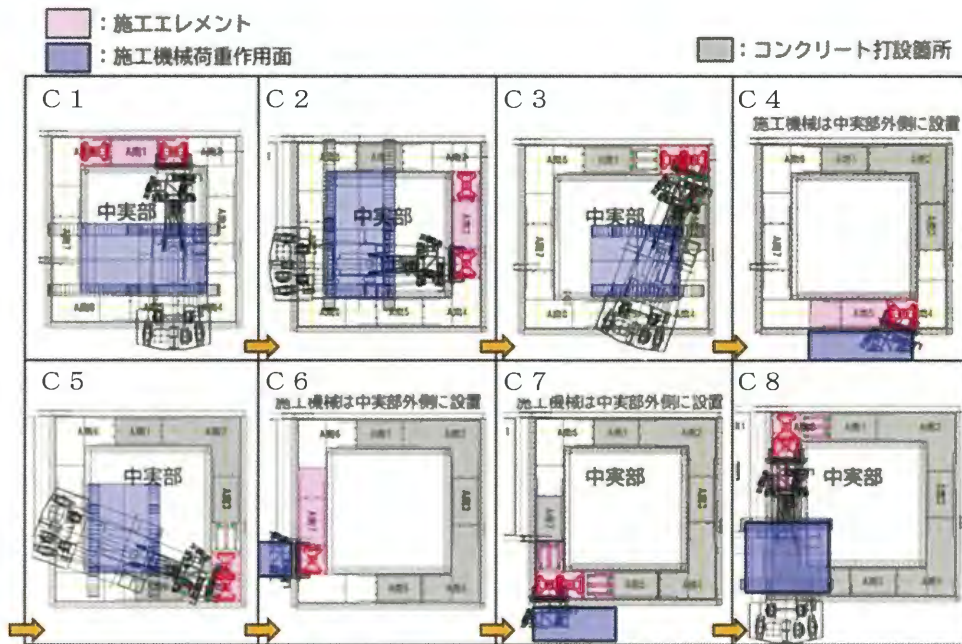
各ステップの施工機械の位置（施工機械荷重の履歴）（南基礎）
